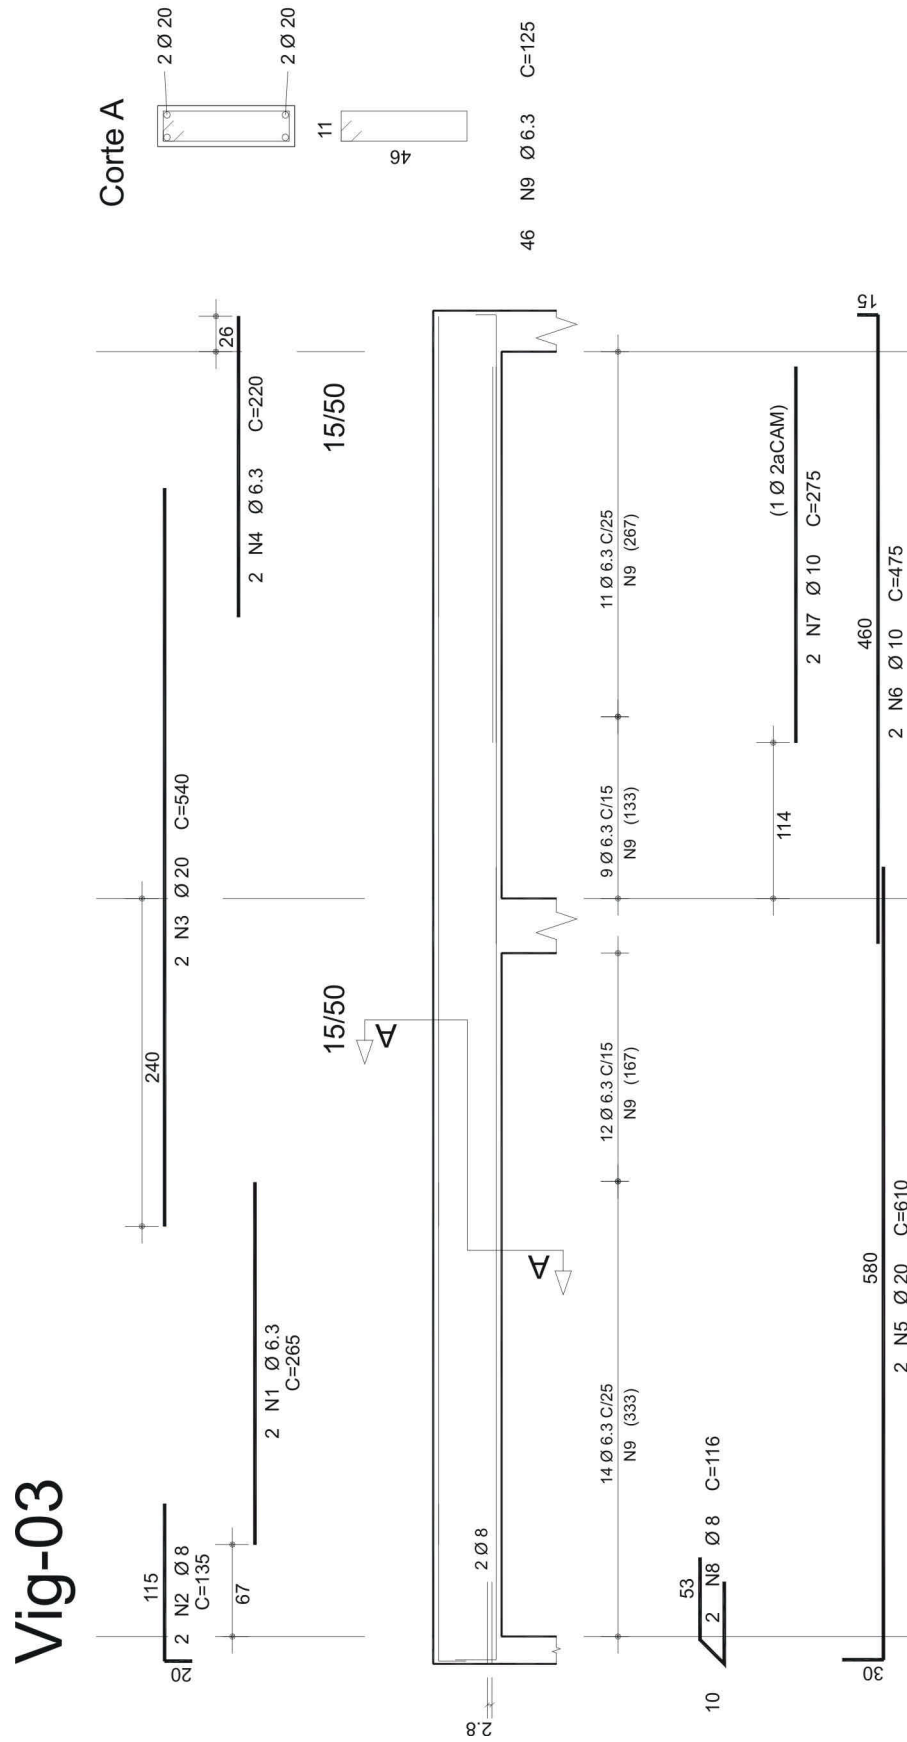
Detalhamento Viga 03, realizado pelo CAD/TQS.
